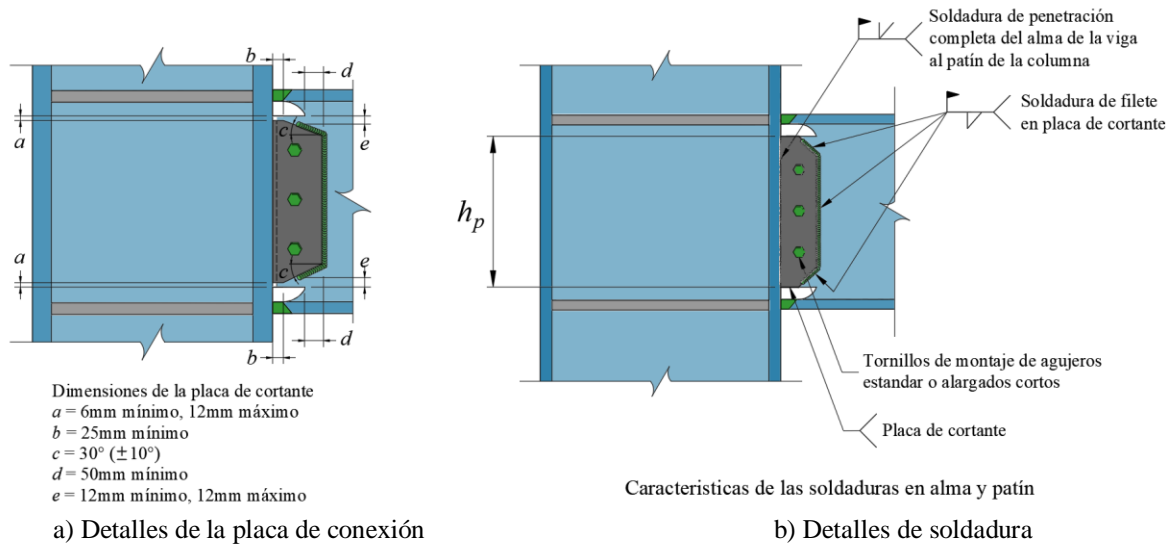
Detalles de conexión de patines y alma soldada
